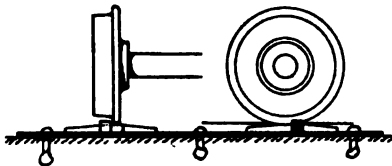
Drehscheibe für Sandwagen (Grundriß).
